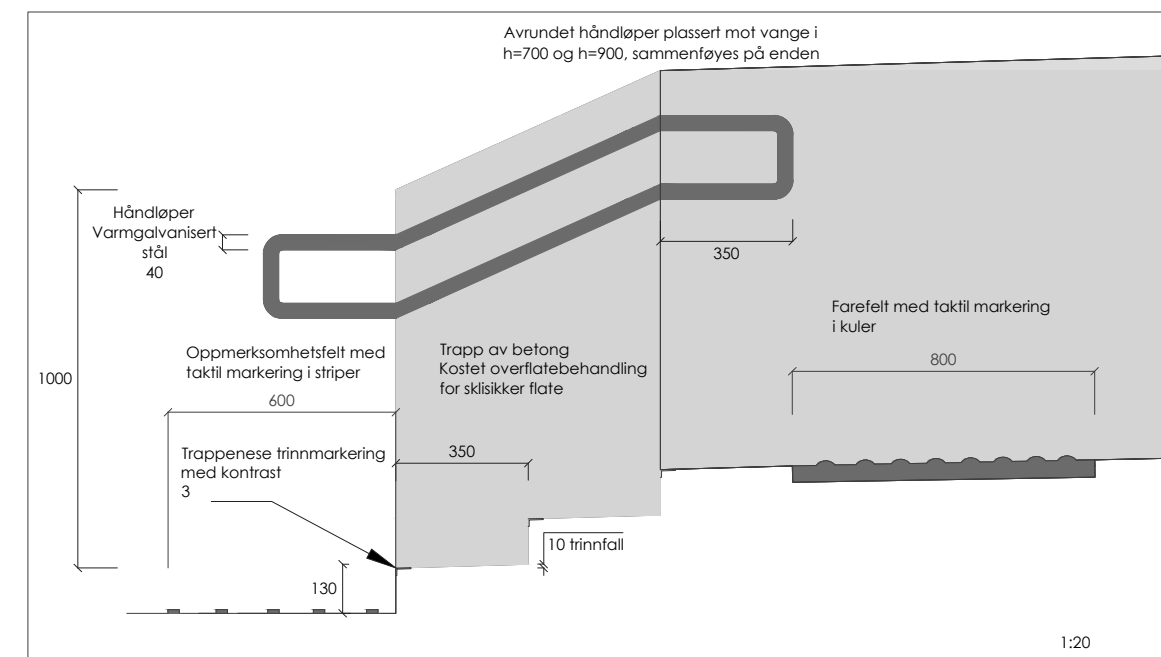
Teknisk detaljplan av førsteklassetrappa, en kompleks konstruksjon
